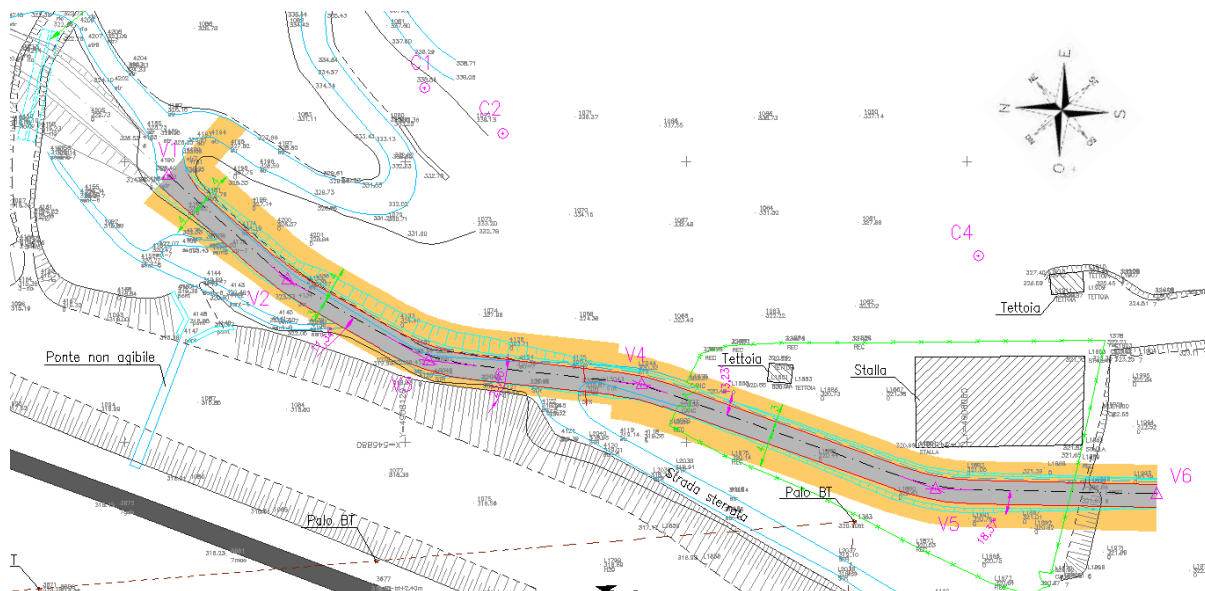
Sviluppo planimetrico della strada di nuova realizzazione ID41
